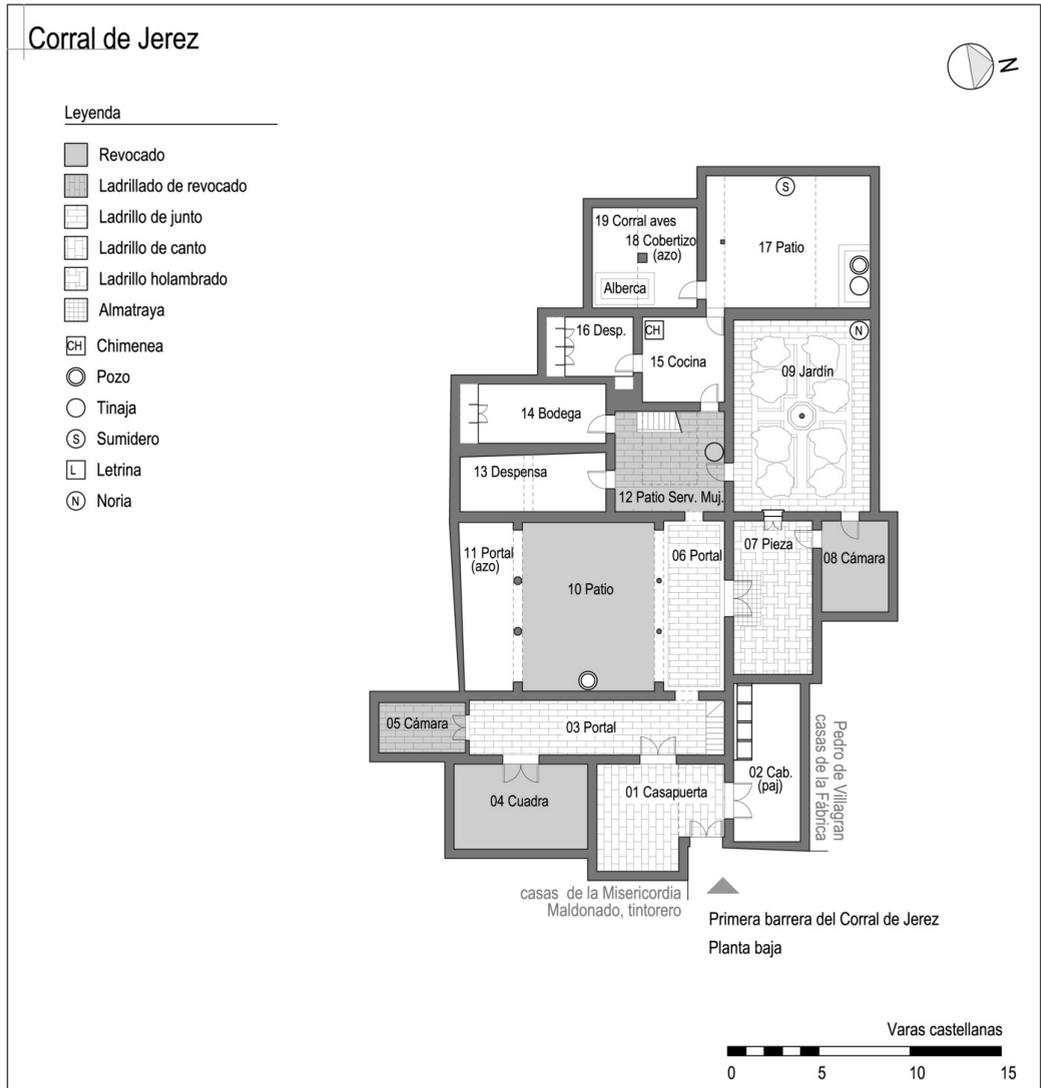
Planta baja de la casa en Corral de Jerez [Fuente: La autora].
